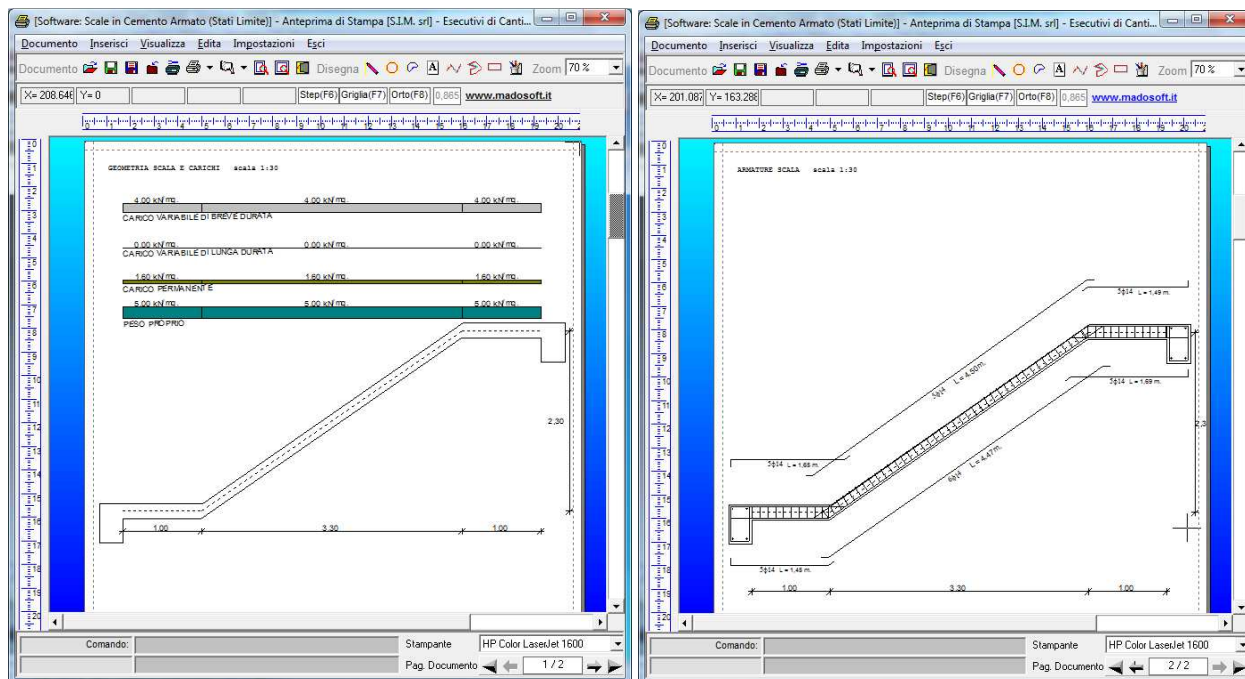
Anteprima di stampa (Esecutivi di Cantiere)
